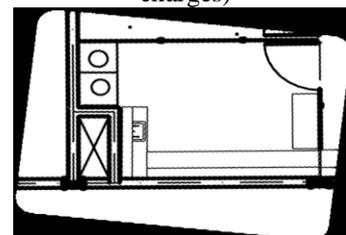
Plan d'une station de stérilisation. (Source : MEAAD Ahmed, 2015, page 24)
